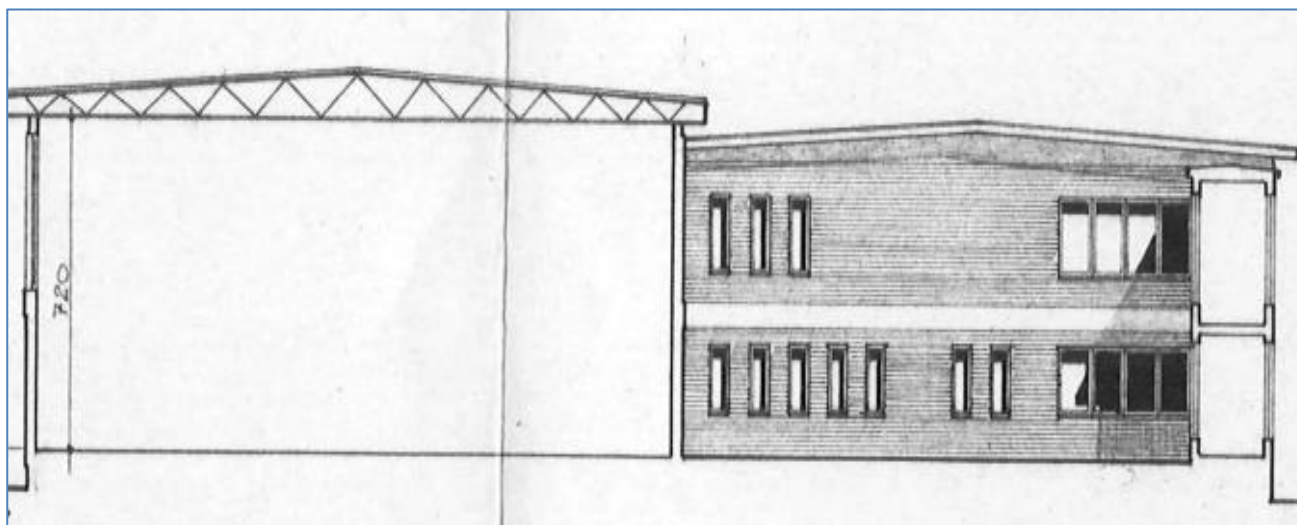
Scuola “A. Fiori” di Formigine: Palestra - Sezione architettonica dell’epoca.
